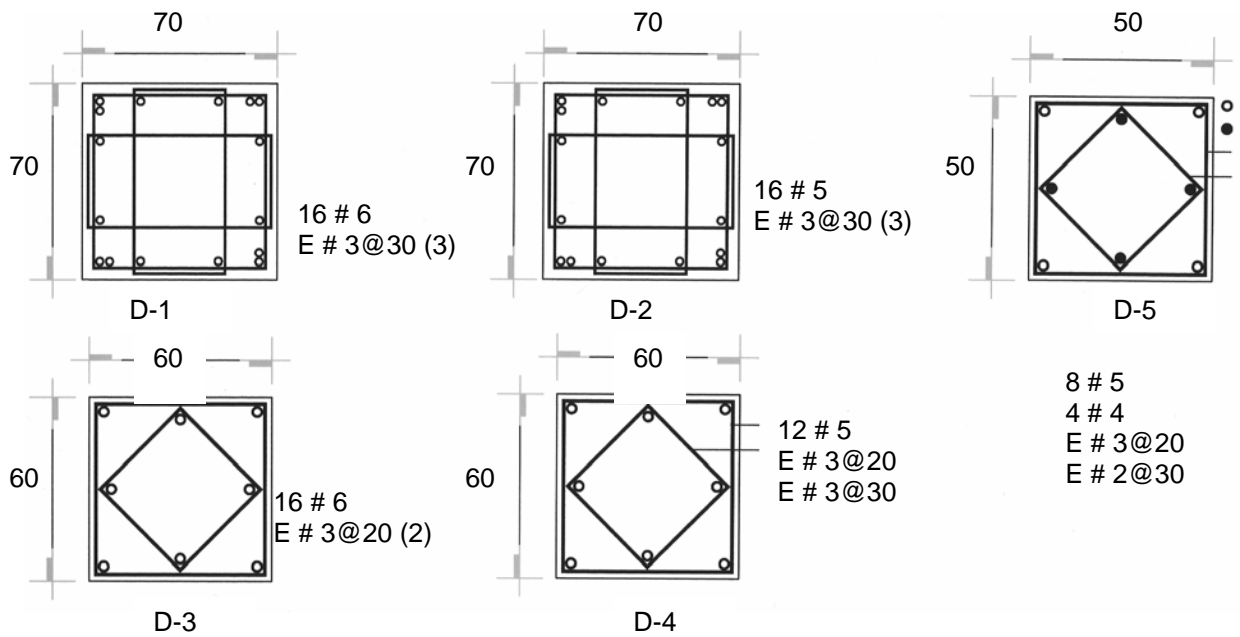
Detalle de dados, dimensiones, tipo de armado y especificación del armado
